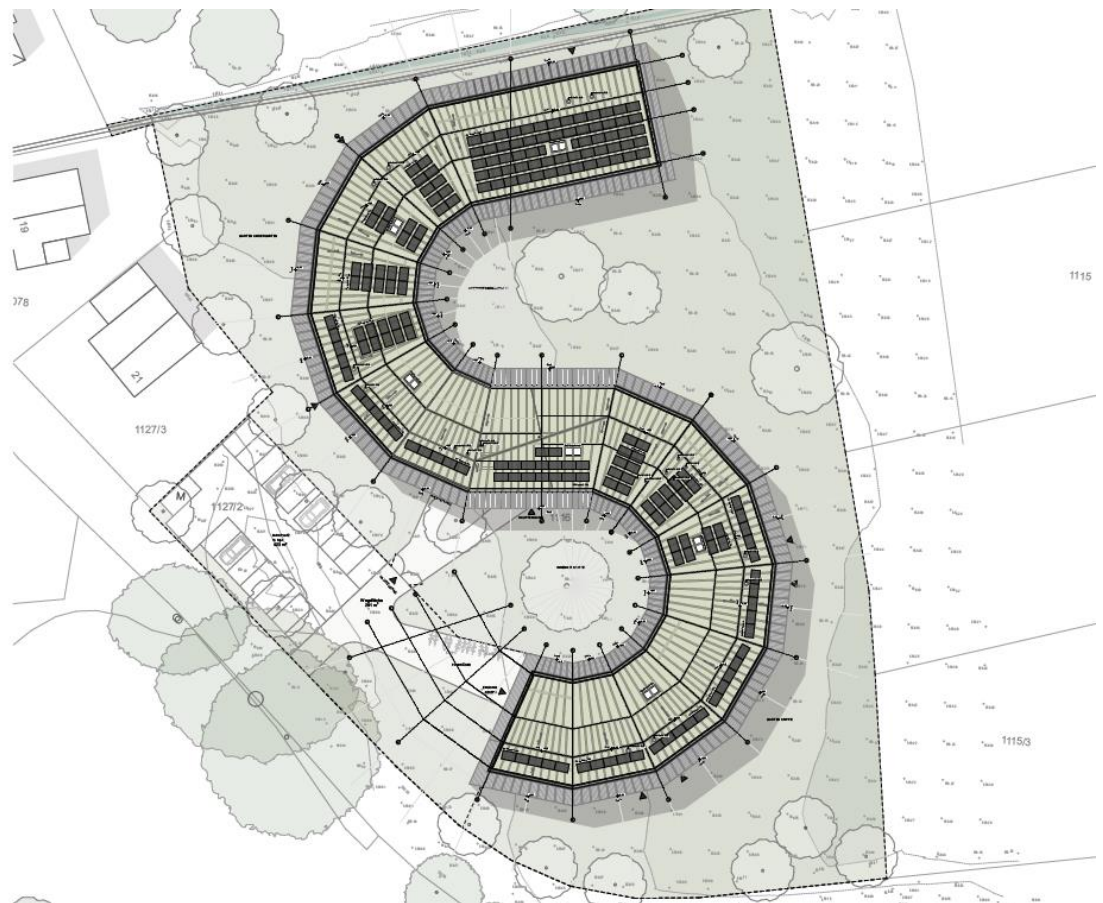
Lageplan der geplanten Kindertagesstätte vom 15.02.2024, Mahlknecht Herrle Architektur, ohne Maßstab
